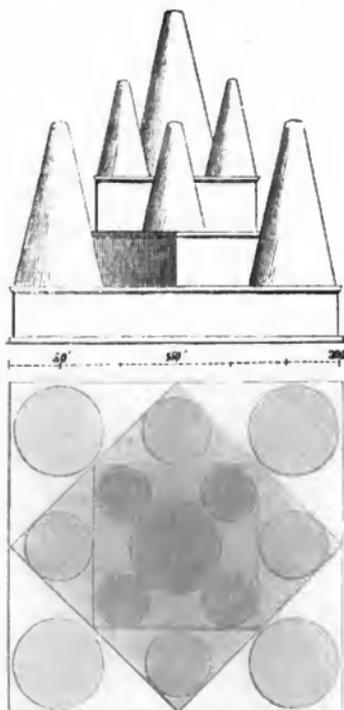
Restaurirter Grundriss und Aufriss des Porsenagräbes.
